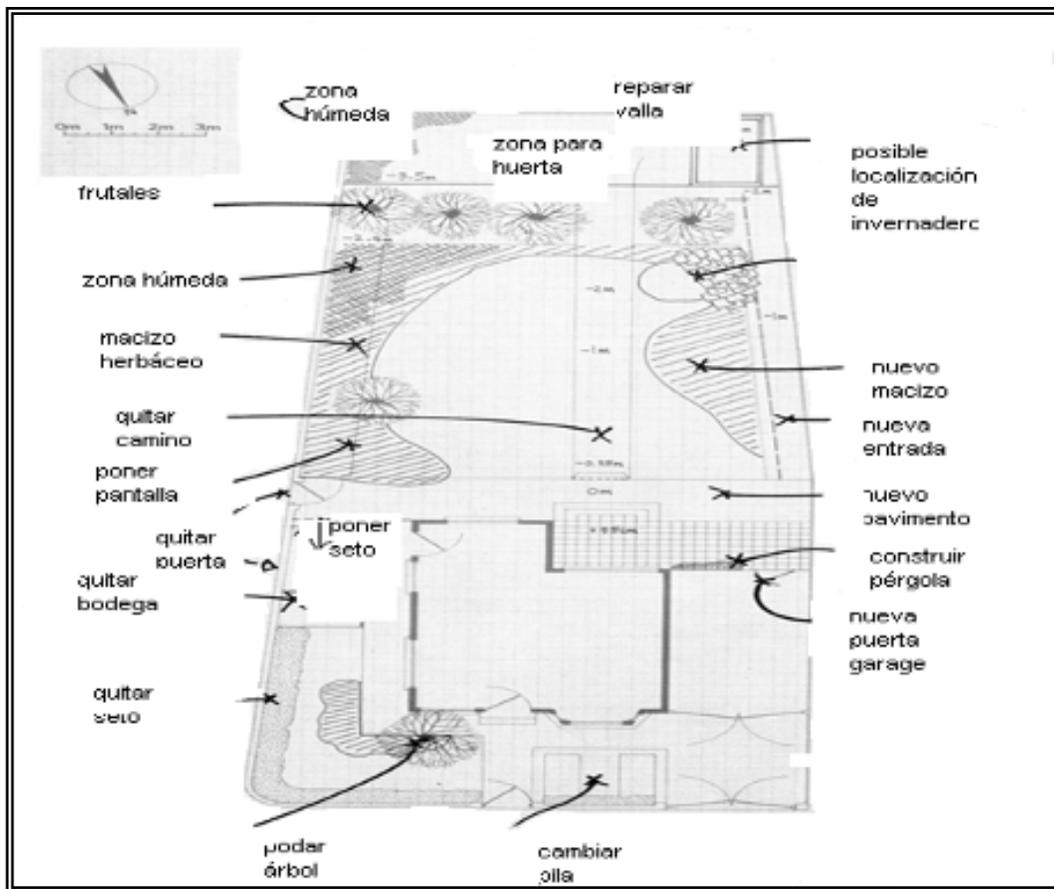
Plano del lugar. Fuente: Plantas de jardín.
